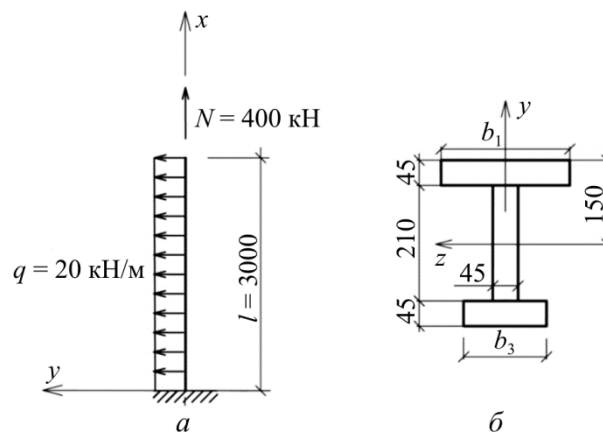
К расчету стойки: а – расчетная схема; б – поперечное сечение
